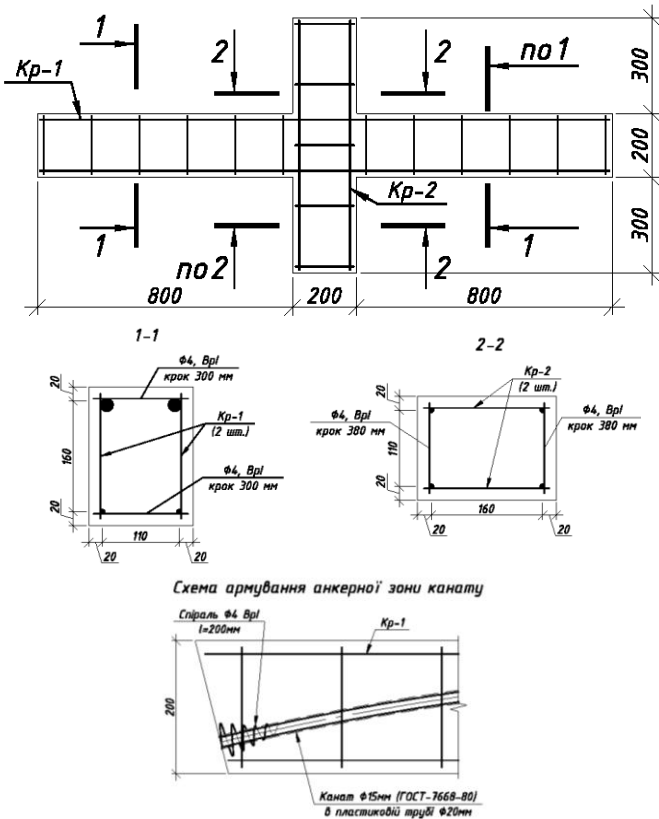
Схема армування зразків не напружуваною та поперечною арматурою
